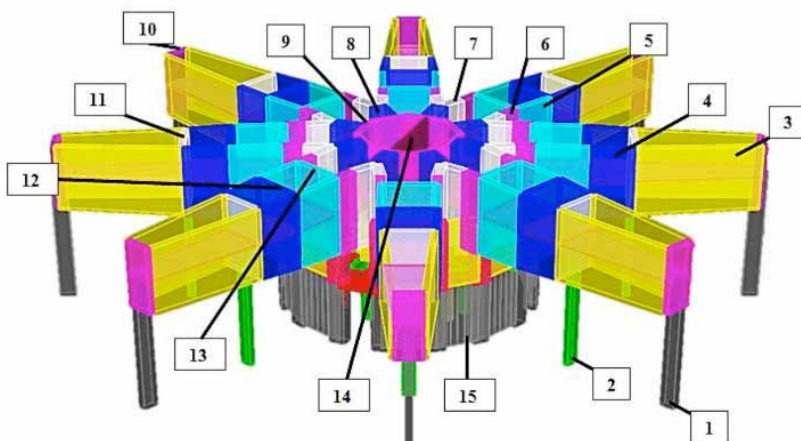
Elementos estruturais das vigas de cobertura modelados, bloco A.
